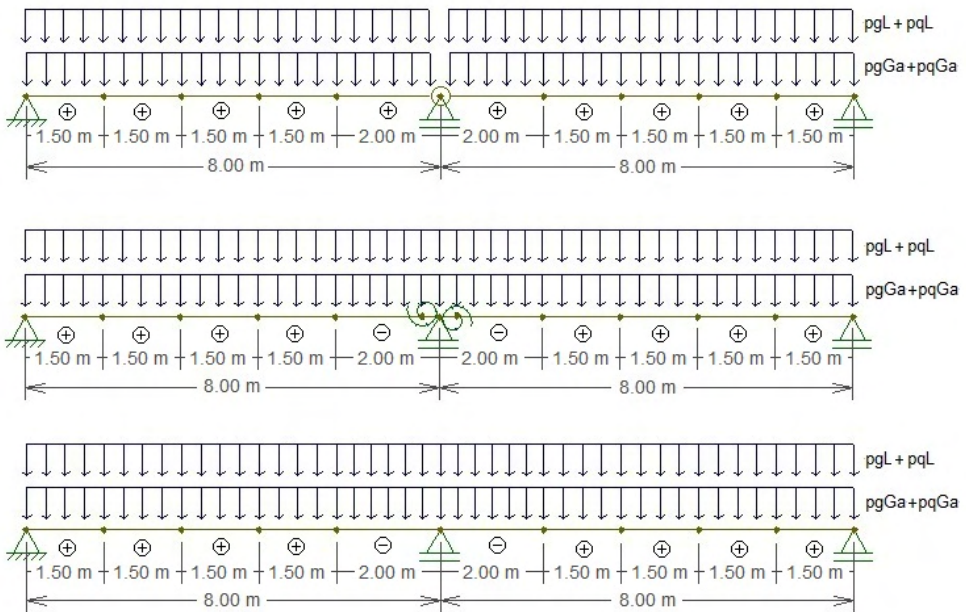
Modelos estruturais de barras da viga mista estudada.
